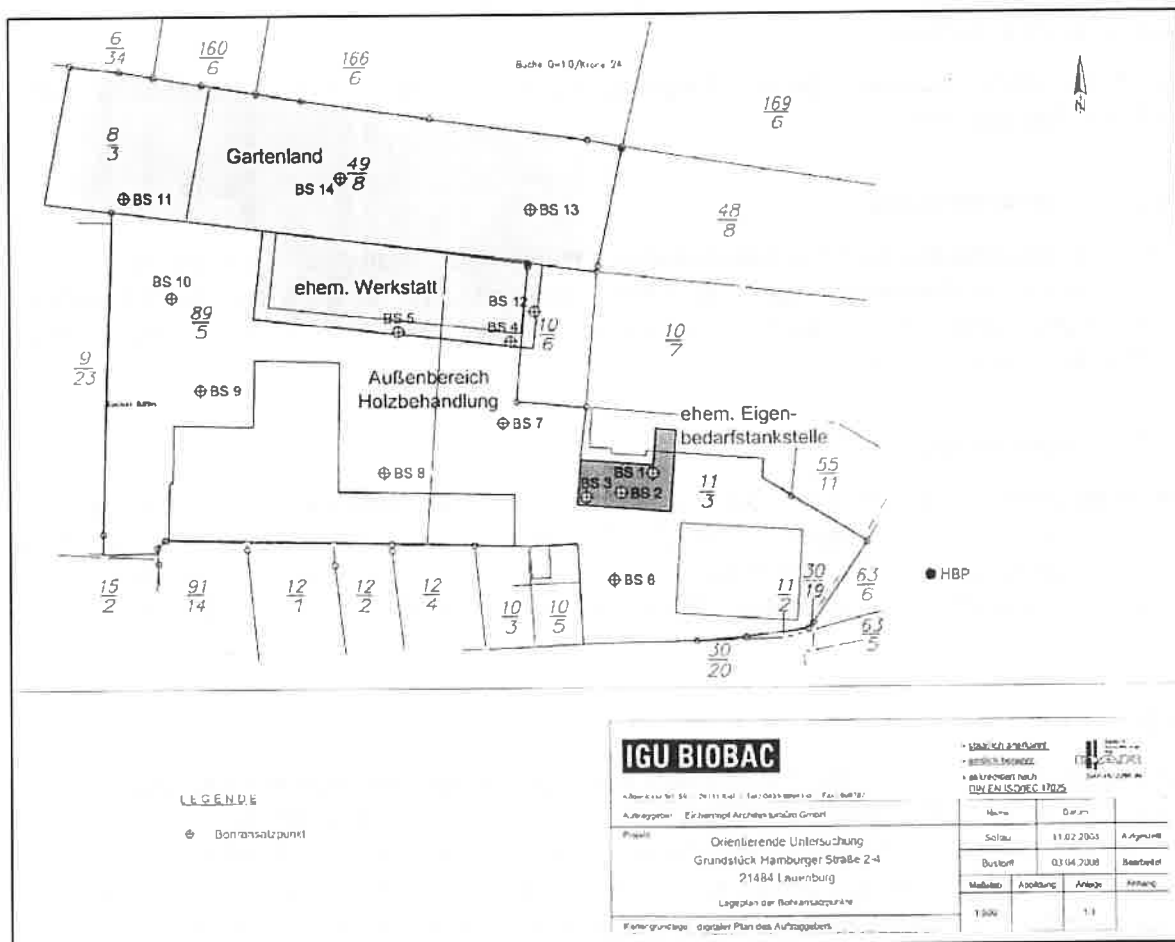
Orientierende Untersuchung Grundstück Hamburger Straße 2-4, 21484 Lauenburg; Lageplan der Bohrersatzpunkte; IGI BIOBAC; April 2008, ohne Maßstab
